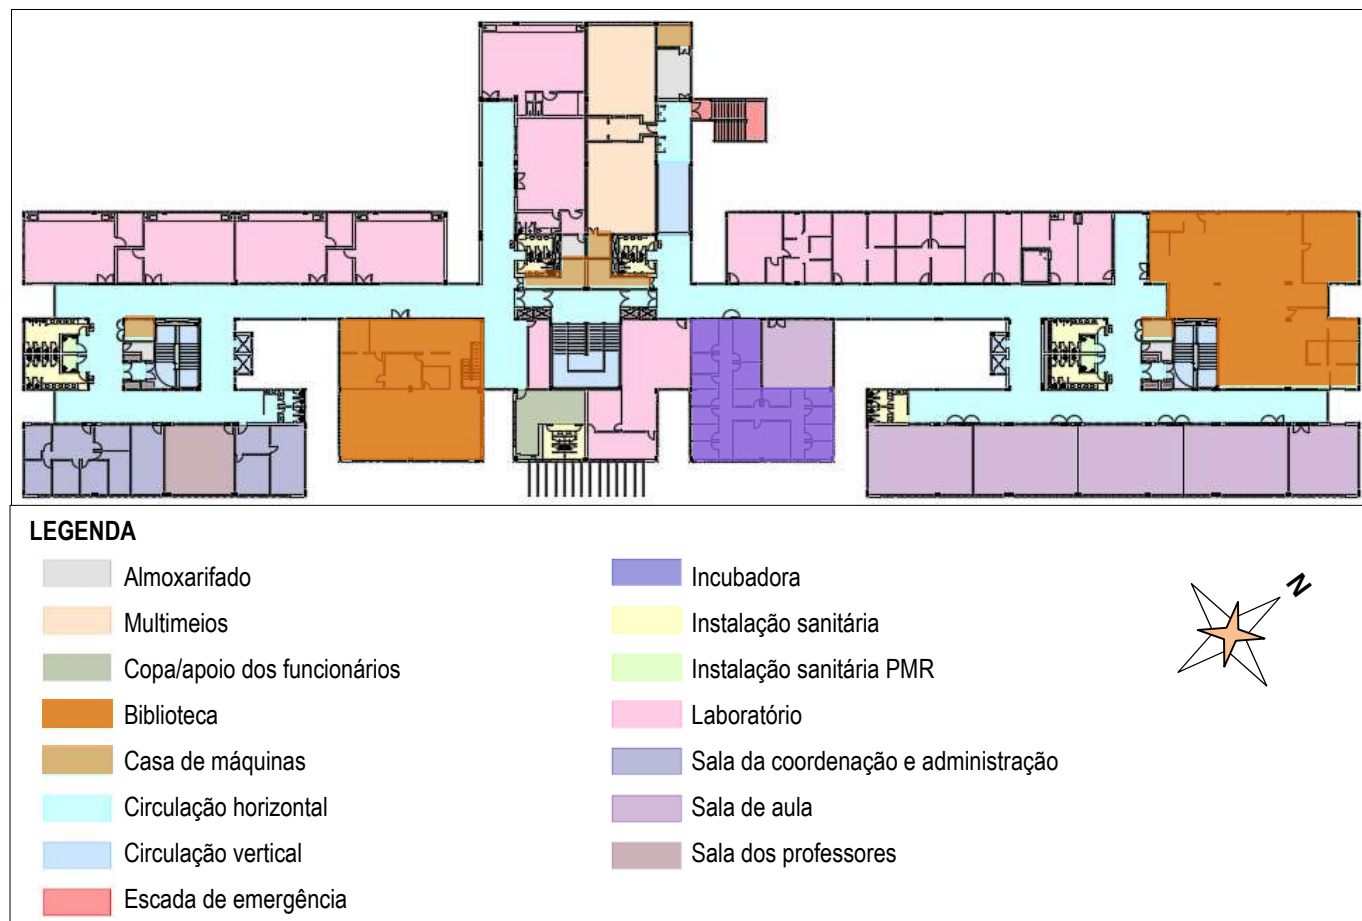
Planta setorizada do primeiro pavimento do bloco 04.
